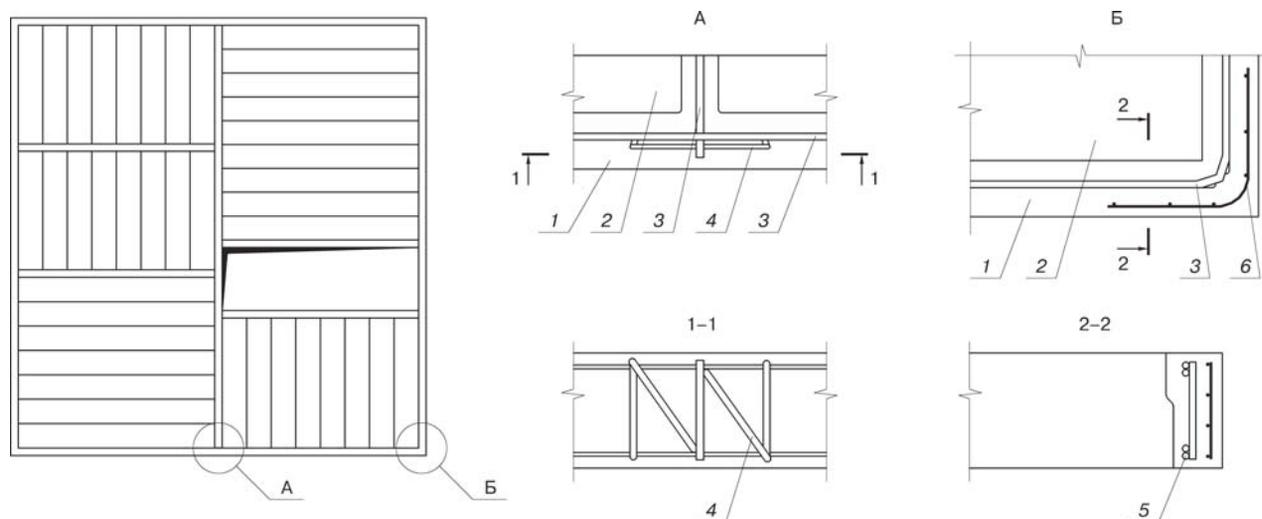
Армирование обвязочного контура: А – Т-образное сопряжение; Б – угловое соединение: 1 – монолитный обвязочный контур; 2 – ячеисто-бетонная плита; 3 – арматурные каркасы; 4 – Г-образные стержни; 5 – замыкающий Г-образный элемент; 6 – гнутая сетка
